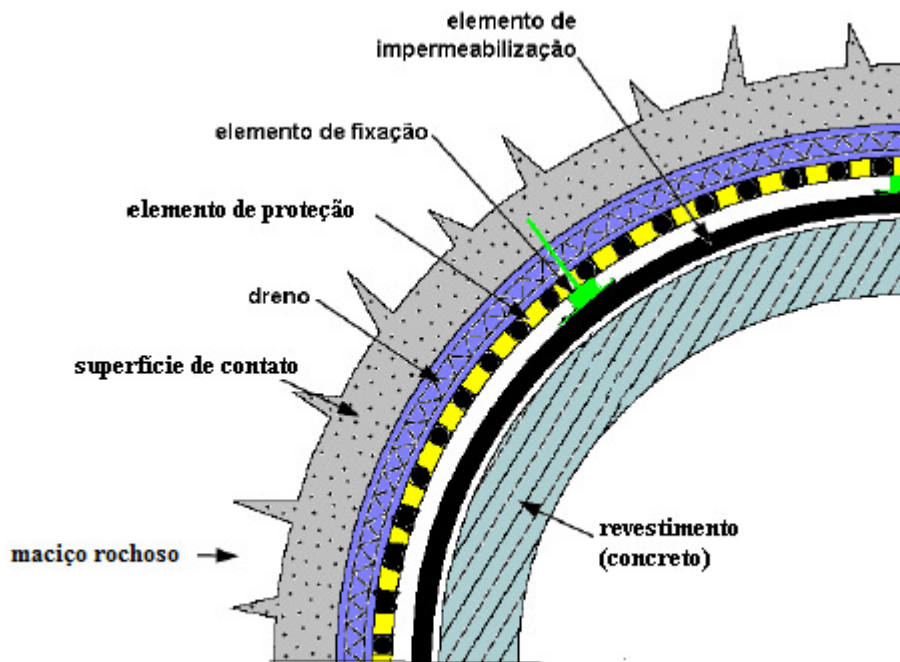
Sistema de impermeabilização e drenagem em túneis
